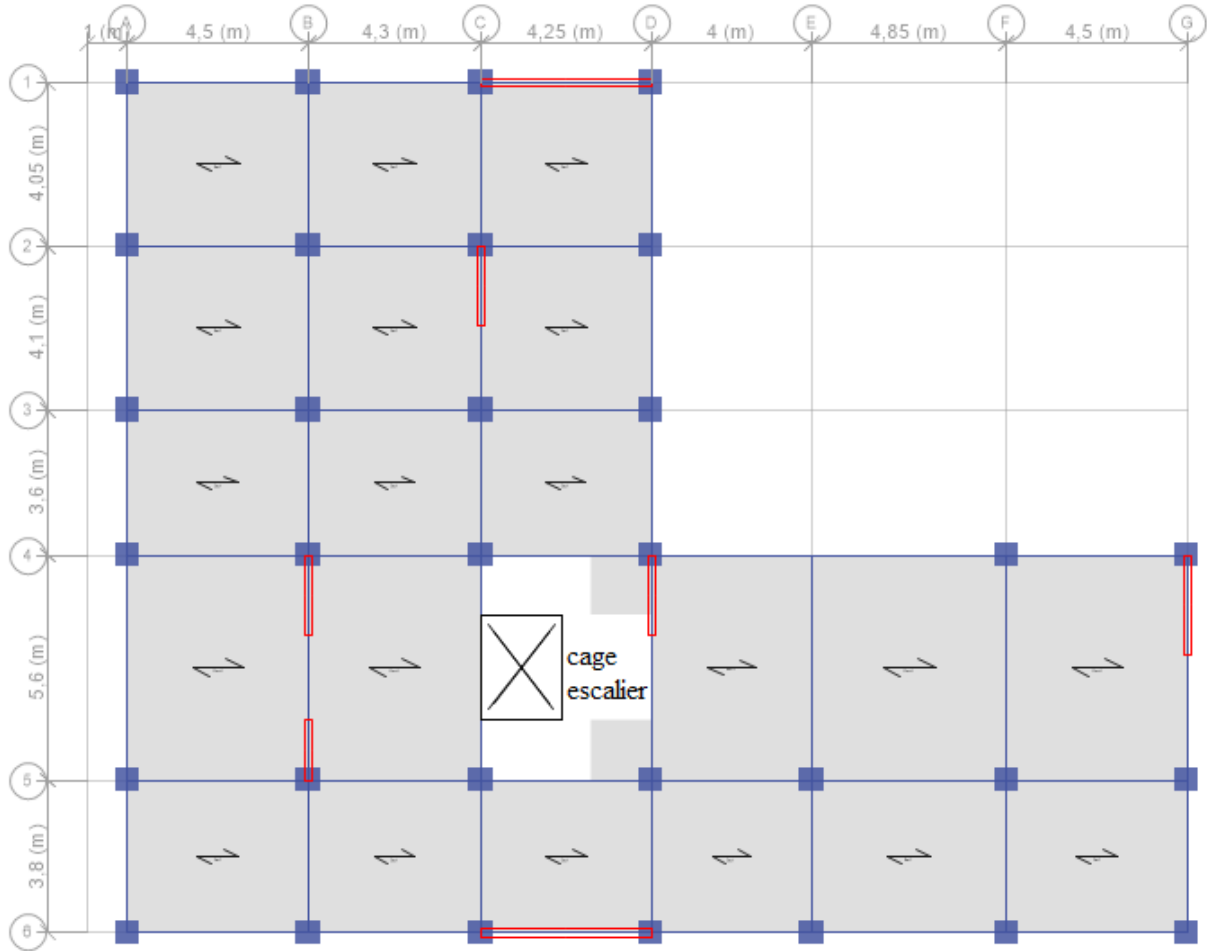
Schéma de la disposition des poutrelles pour étage 1.
